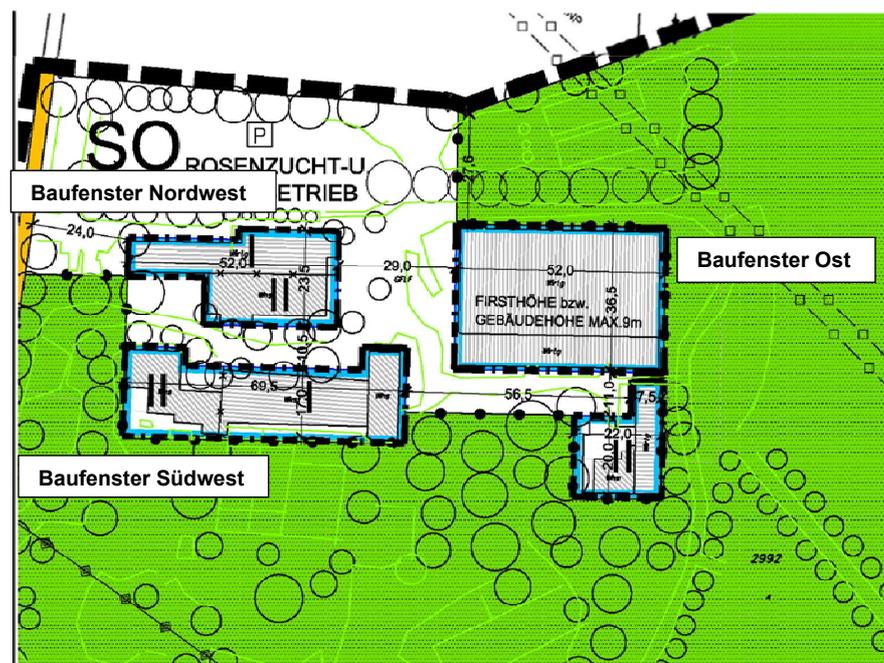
Ausschnitt Änderungsbereich Rechtskräftiger Bebauungsplan
